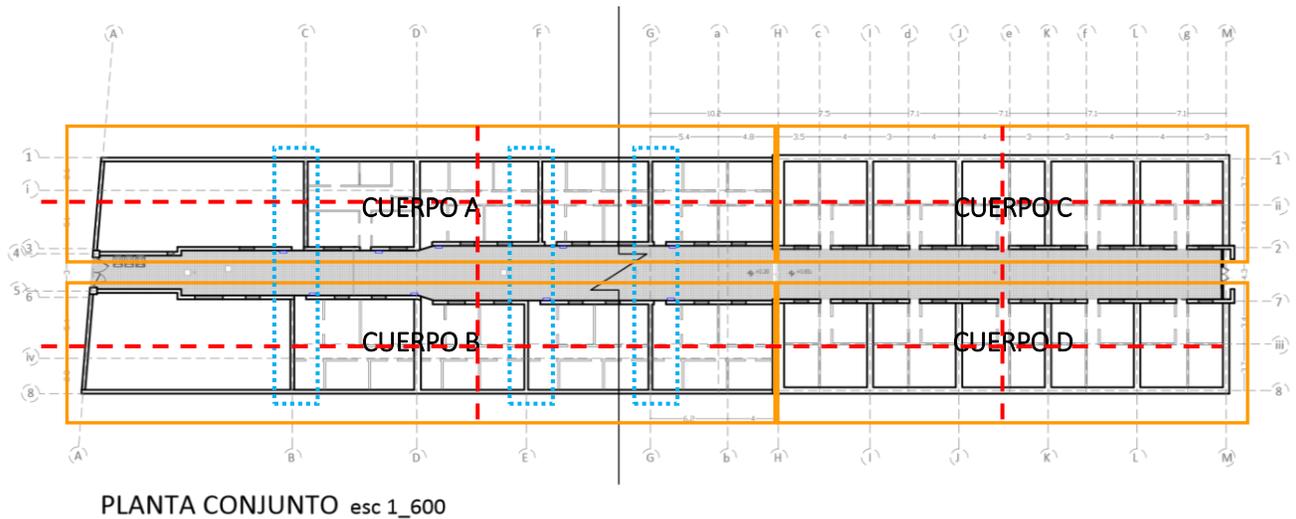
Planta Conjunto ESTRUCTURA Eje ROJO: Ejes de simetría horizontal y vertical.
